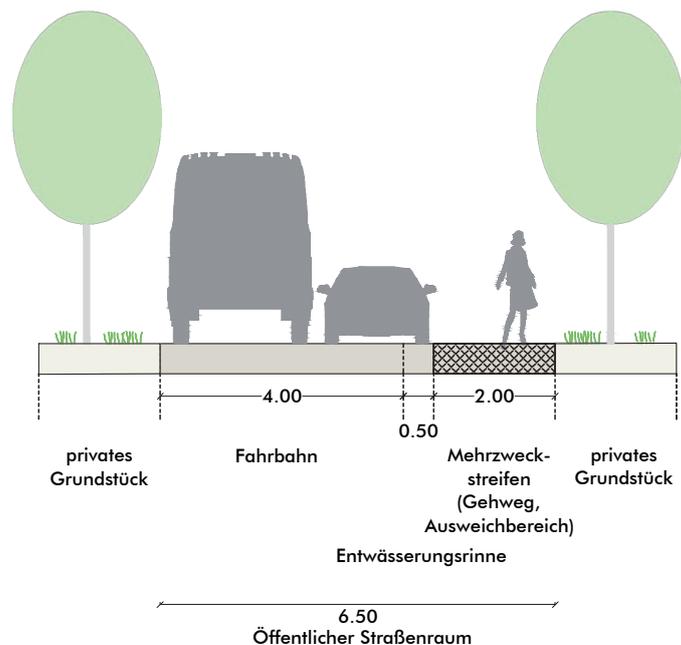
Querschnitt der geplanten Erschließungsstraße, unmaßstäblich
